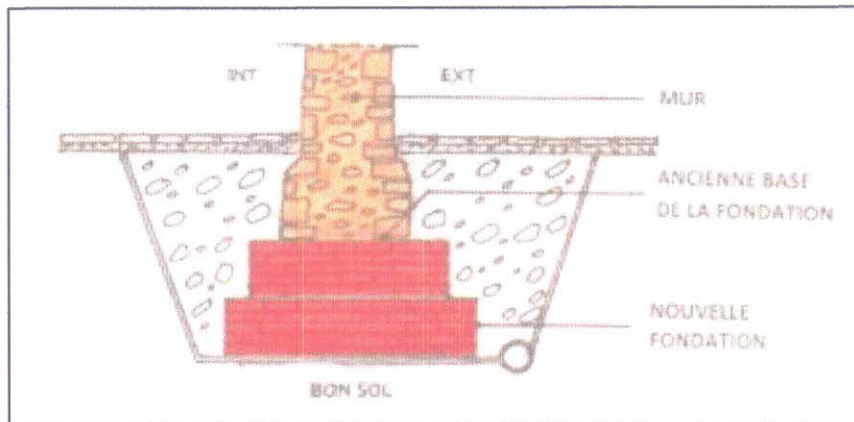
Consolidation de la fondation en sous-œuvre par maçonnerie.
